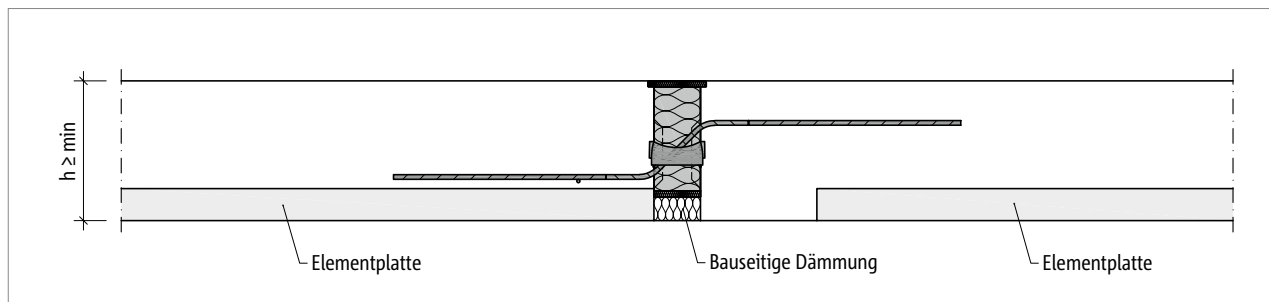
Schöck Isokorb® T Typ QL: Elementdecke mit aufgesetzten Schöck Isokorb®
